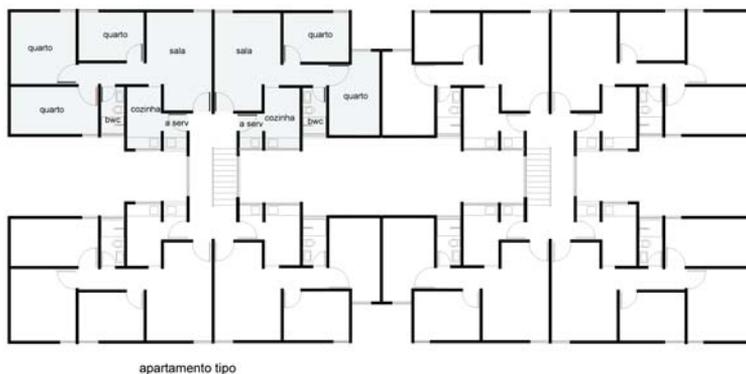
Planta-baixa do bloco típico do Conjunto Cohab Curado 3.
